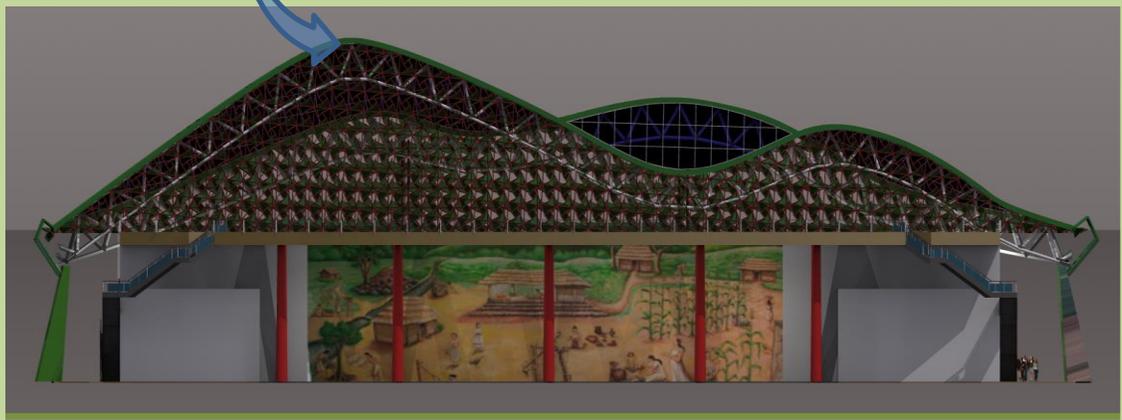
Fachada norte - Coliseo Deportivo - Fuente: Elaboración propia
